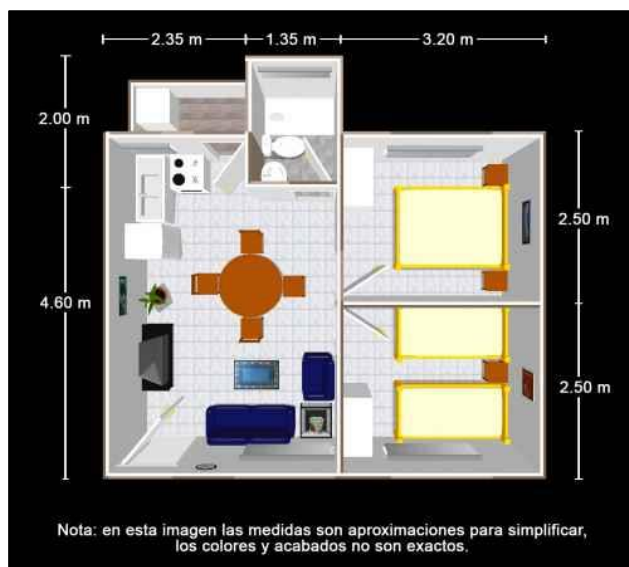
Planta Arquitectónica. Casa para Todos. SIN ESCALA.
